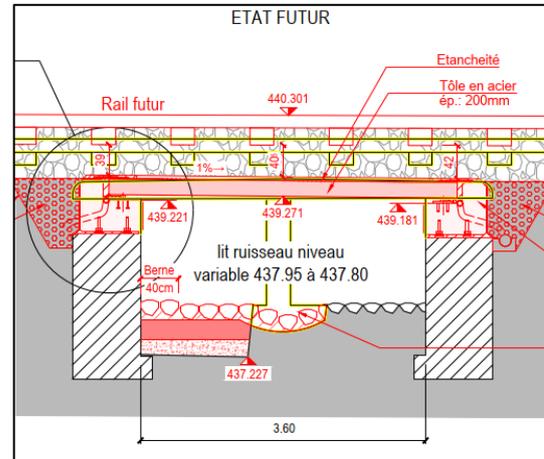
Coupe aqueduc démolì - Extrait plan PGSA
